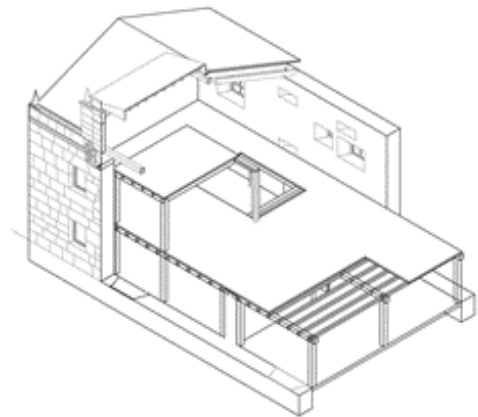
Axonometría explicativa donde se vería como se colocaría la estructura de madera laminada.
